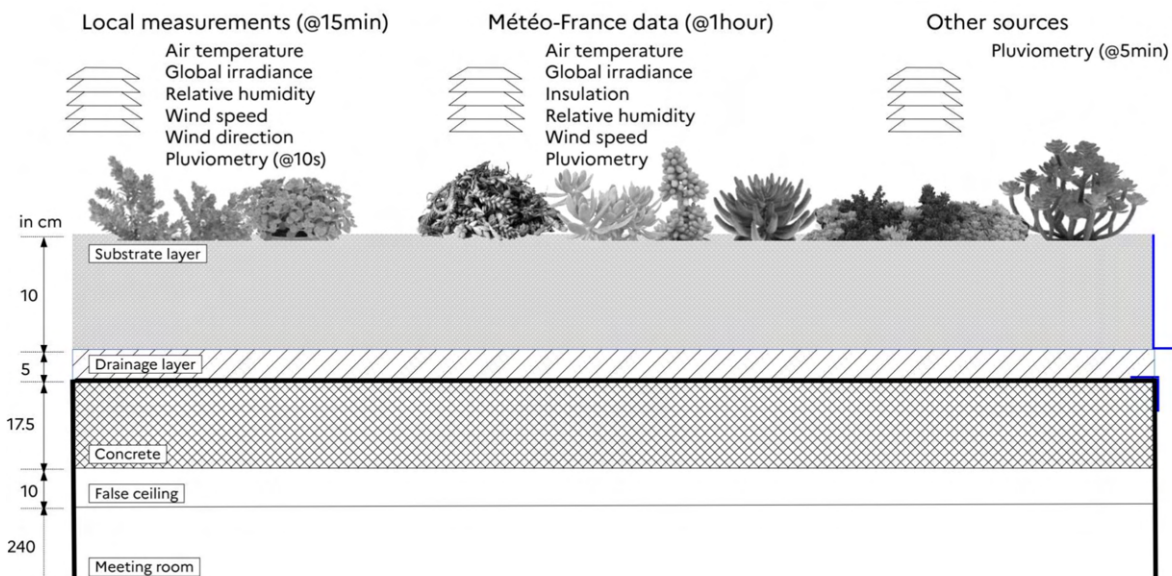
Plan de l'instrumentation sur la plateforme *Plateau Calcaire*.
